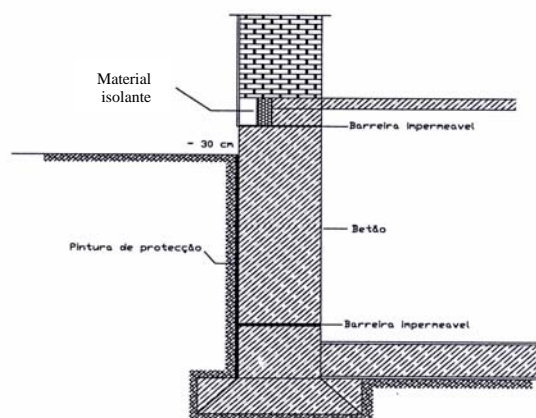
Colocação de barreiras impermeáveis em parede de cave.
